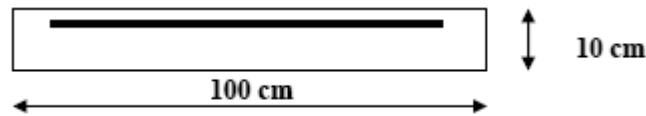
Section théorique pour le ferrailage de l'acrotère
